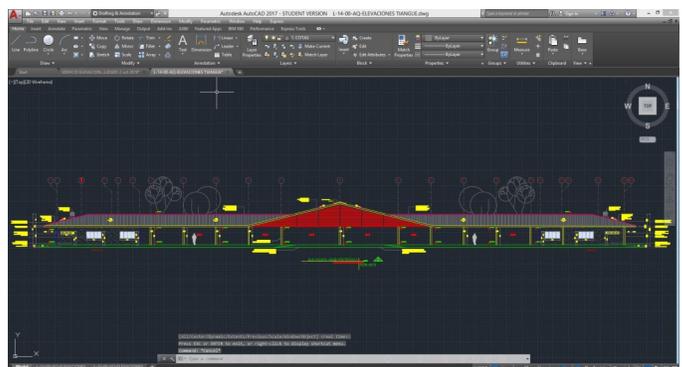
Vista 2D AutoCAD - Edificio Tiangué
